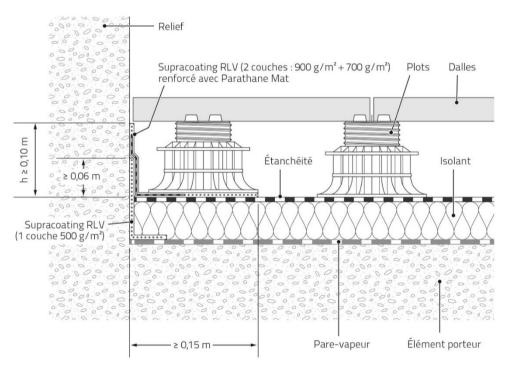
Protection par dalles sur plots : niveau fini des dalles au-dessus du haut des relevés (sans dispositif d'écartement des eaux de ruissellement).
